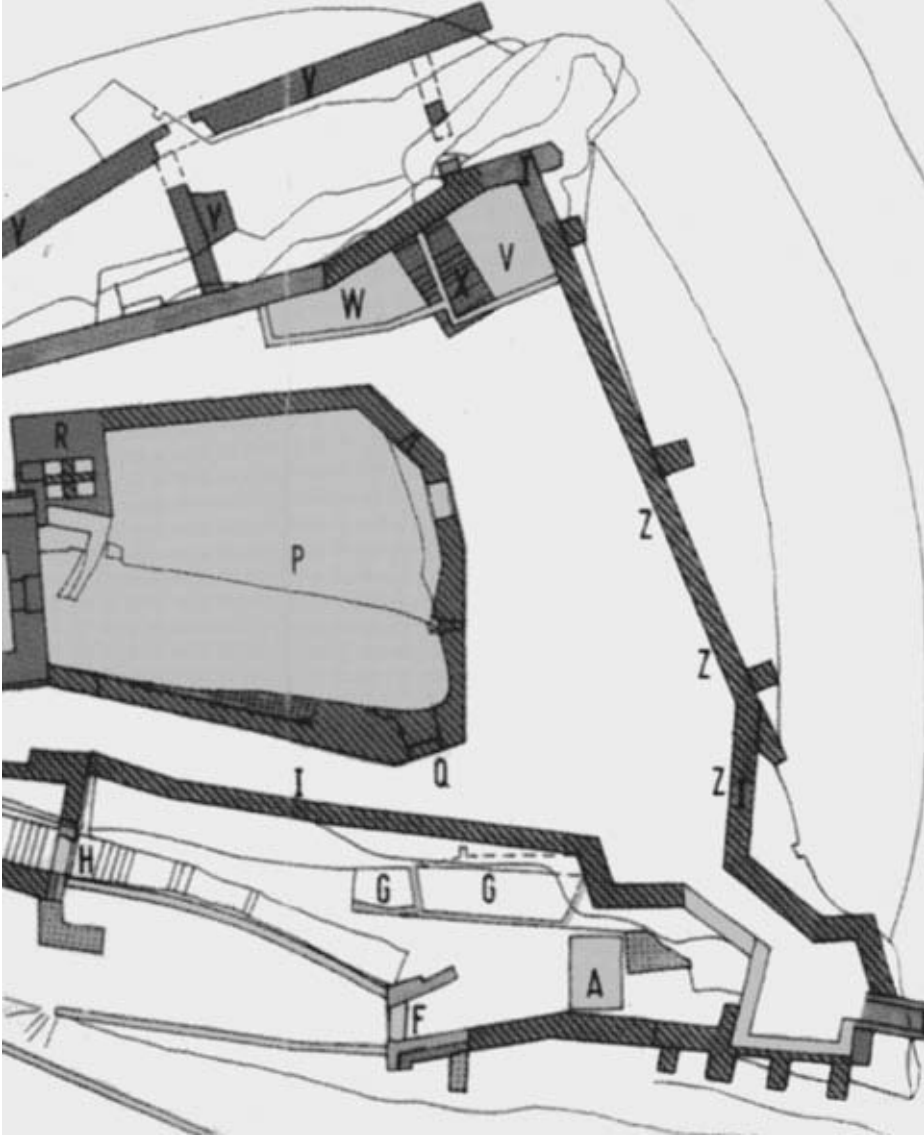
Grundriss der Burg Trifels (Ausschnitt). Aus: Meyer 2001: Beilage.
